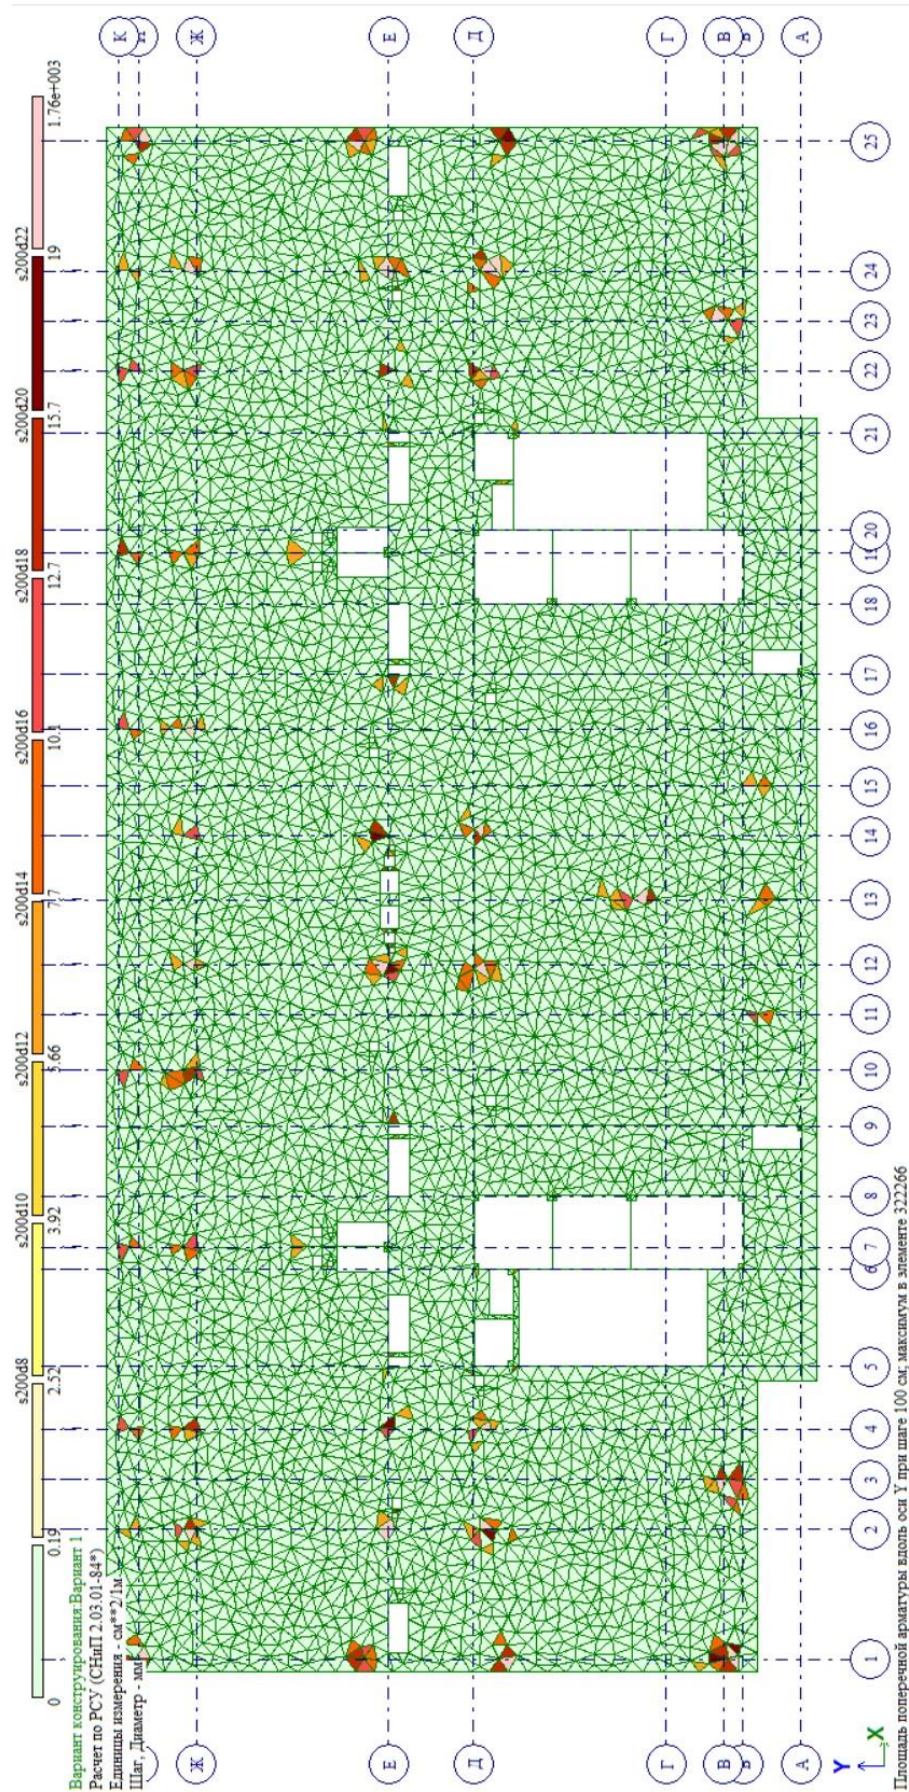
Поперечное армирование плиты вдоль оси У
